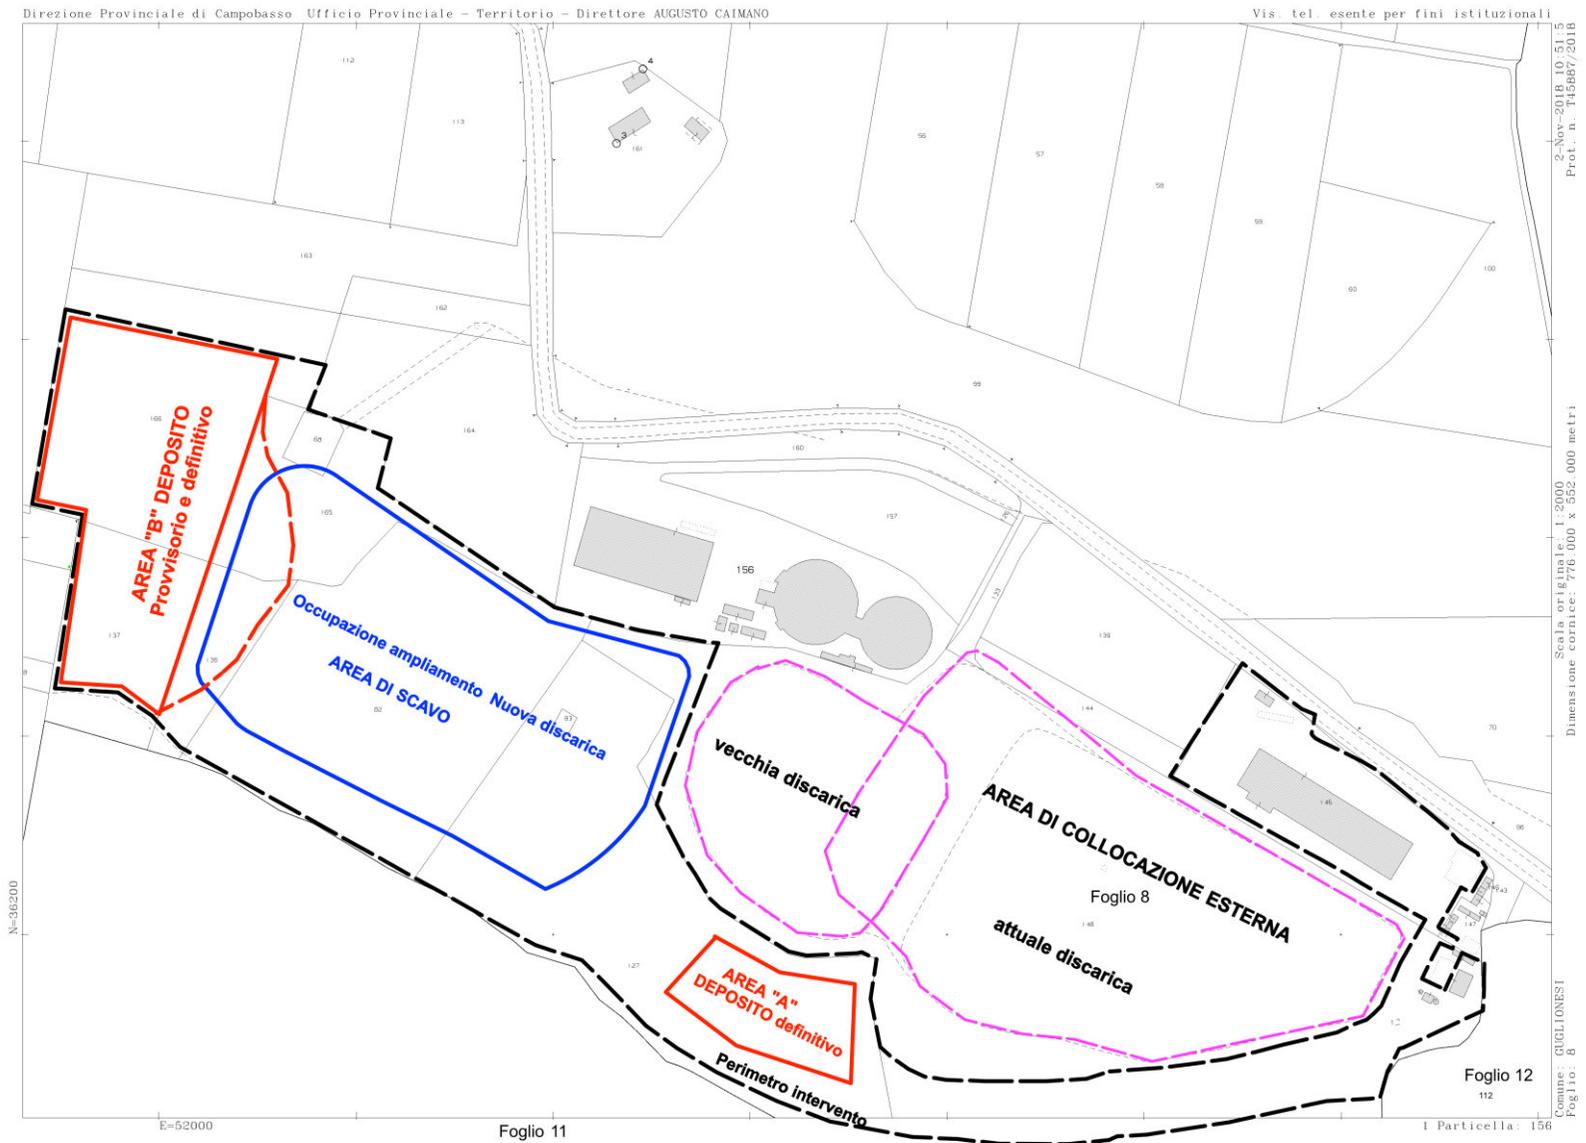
planimetria generale di intervento: assetto “post operam”
